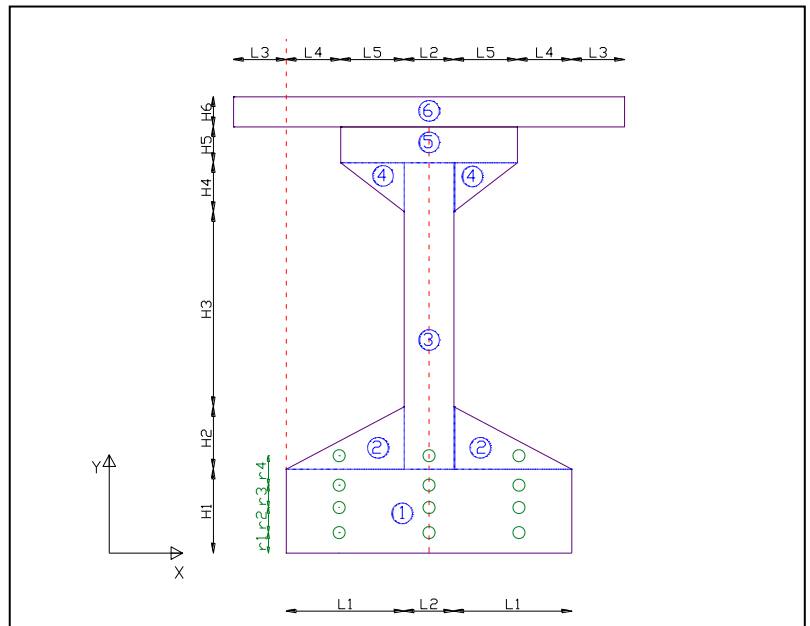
Datos de la geometría de la viga solicitados.
